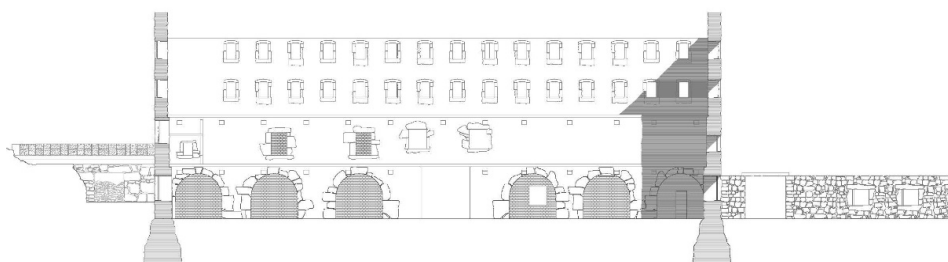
Levantamiento. Estado actual. Sección longitudinal fábrica
